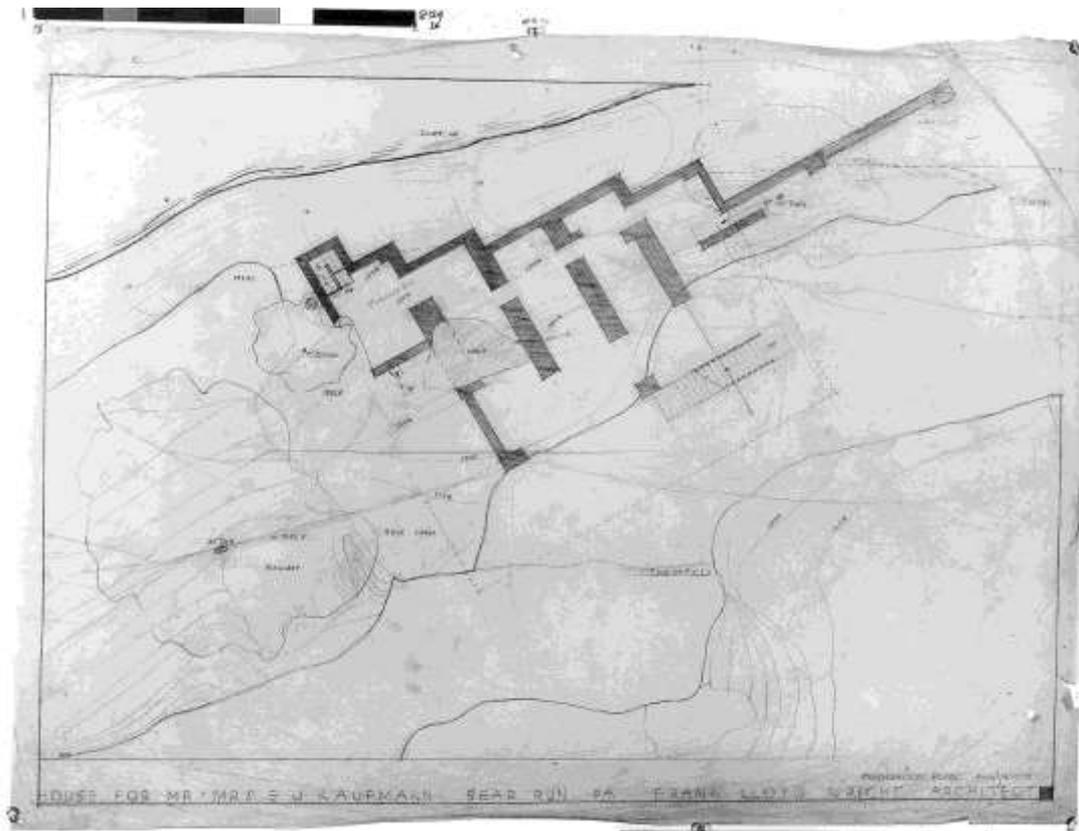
« *Fondation plan scale 1"=1'-0"* » Assise et topographie Columbia FLLW 3602 p.32
